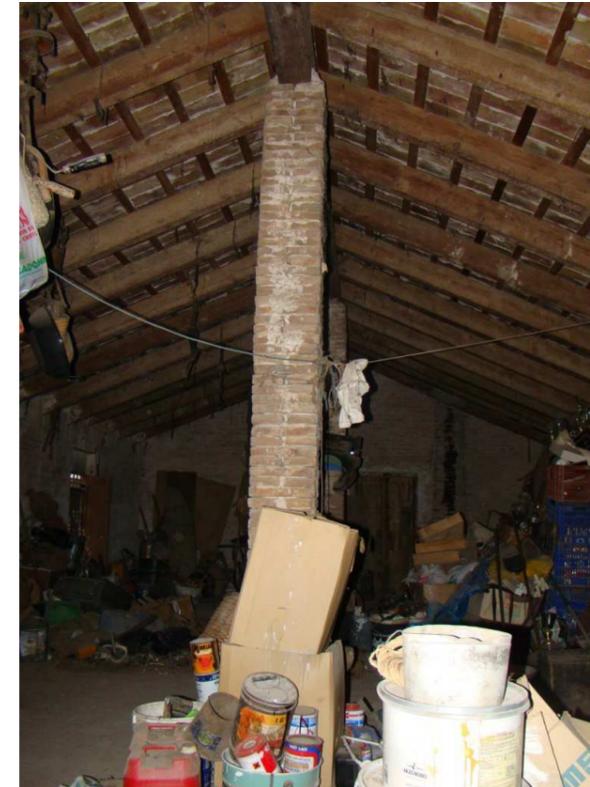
Imagen tomada desde las escaleras de la cambra más grande, fachada este. (Autor propio)
